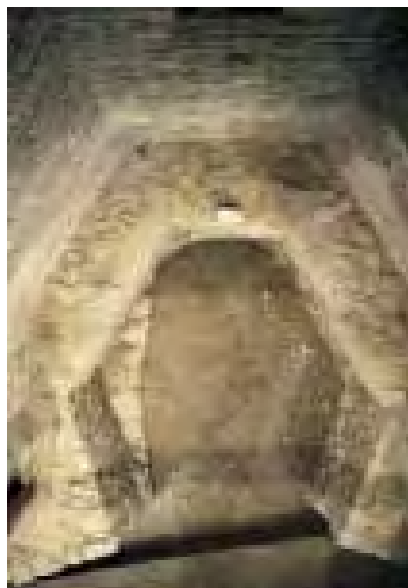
Excavación arqueológica de la capilla central de la girola. Se aprecian a izquierda y derecha, en los alzados de los muros, las fisuras debidas al corrimiento del fondo de la capilla
